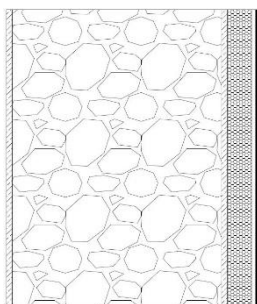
Pormenor construtivo da proposta de reabilitação das paredes exteriores.
